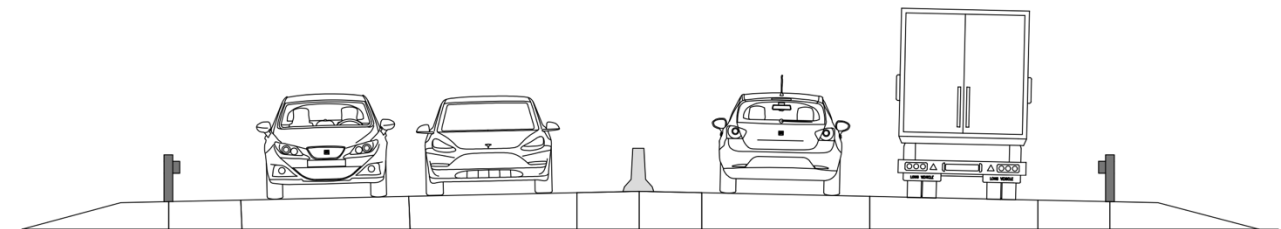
Sección transversal tipo | Fuente: Elaboración propia
